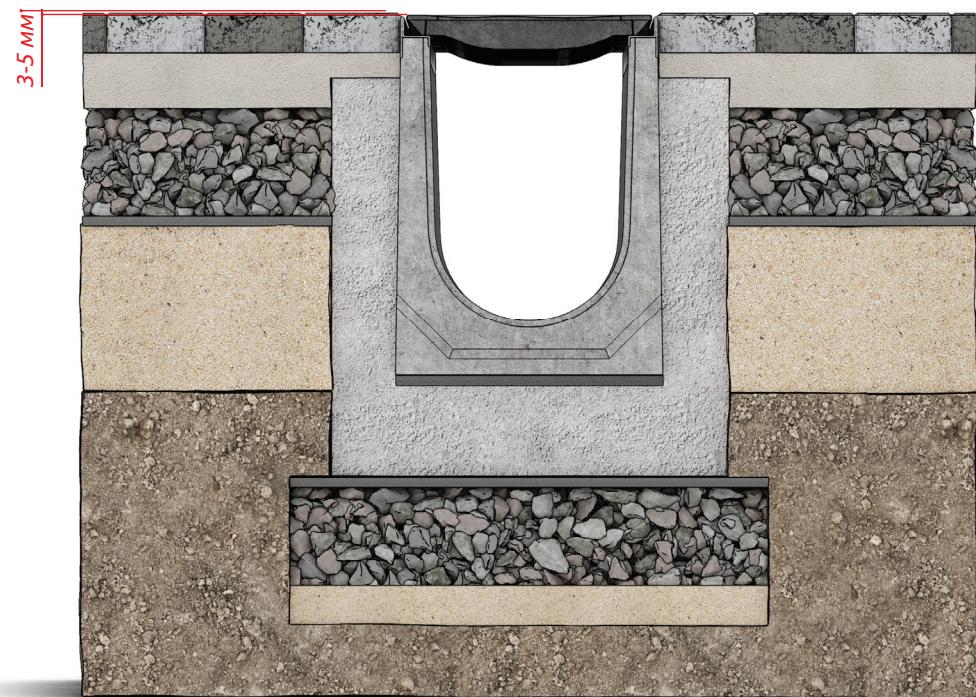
Обратная засыпка и установка примыкающего покрытия (Со схемами монтажа можно ознакомиться в альбоме типовых решений по монтажу бетонных водоотводных лотков и пескоуловителей СТИЛОТ [4]).
